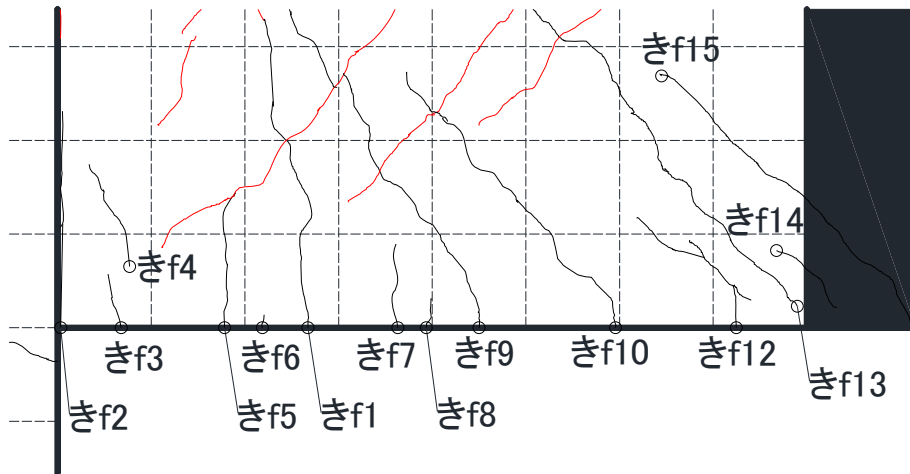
基礎梁ひび割れ幅測定位置(試験体 DR-2 +7.0 サイクル 観測)
